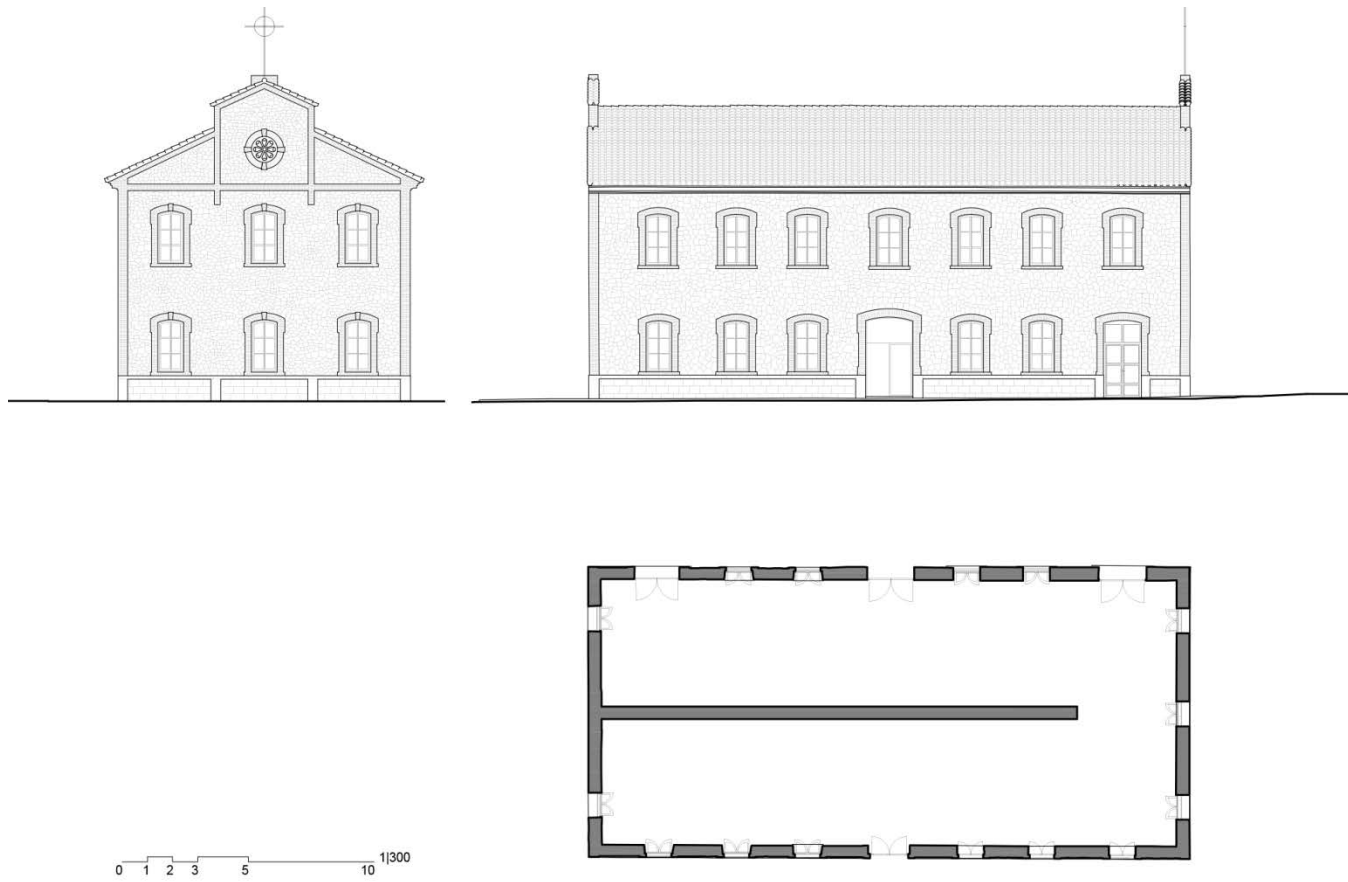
Levantamiento Planimétrico del estado original del Pabellón Central. Comedores. Laboratorios y Clínica.
